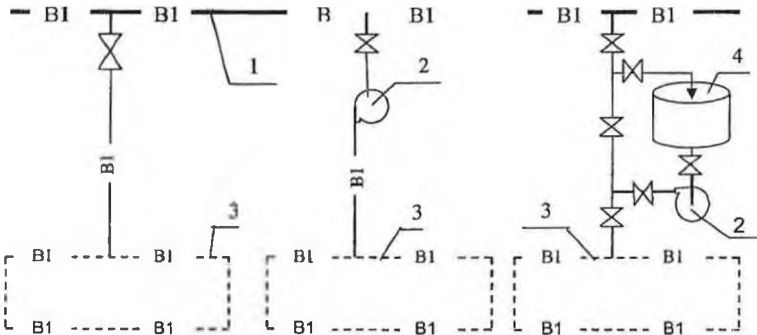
Схемы подключения внутриплощадочных сетей х/п водоснабжения к городскому водопроводу: 1 - трасса городского водопровода; 2 - насосная станция; 3 - внутриплощадочный х/п водопровод; 4 - аккумулятор
